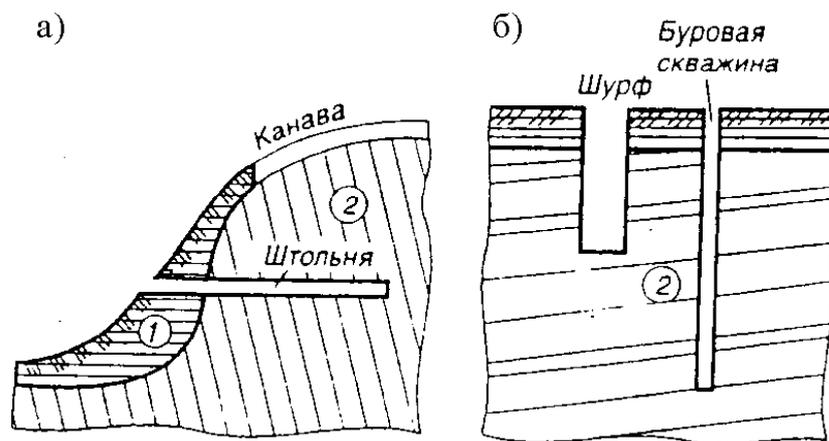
Разведочные выработки: а – горизонтальные (канавы, штольни); б – вертикальные (шурф, буровая скважина); 1 – наносы; 2 – коренные грунты
